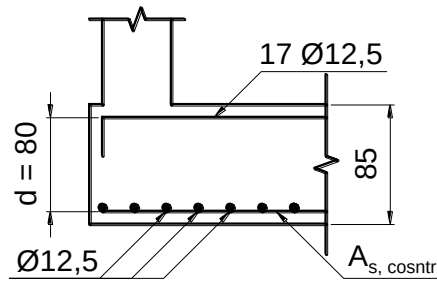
Armaduras longitudinais da sapata sob o pilar de divisa.
